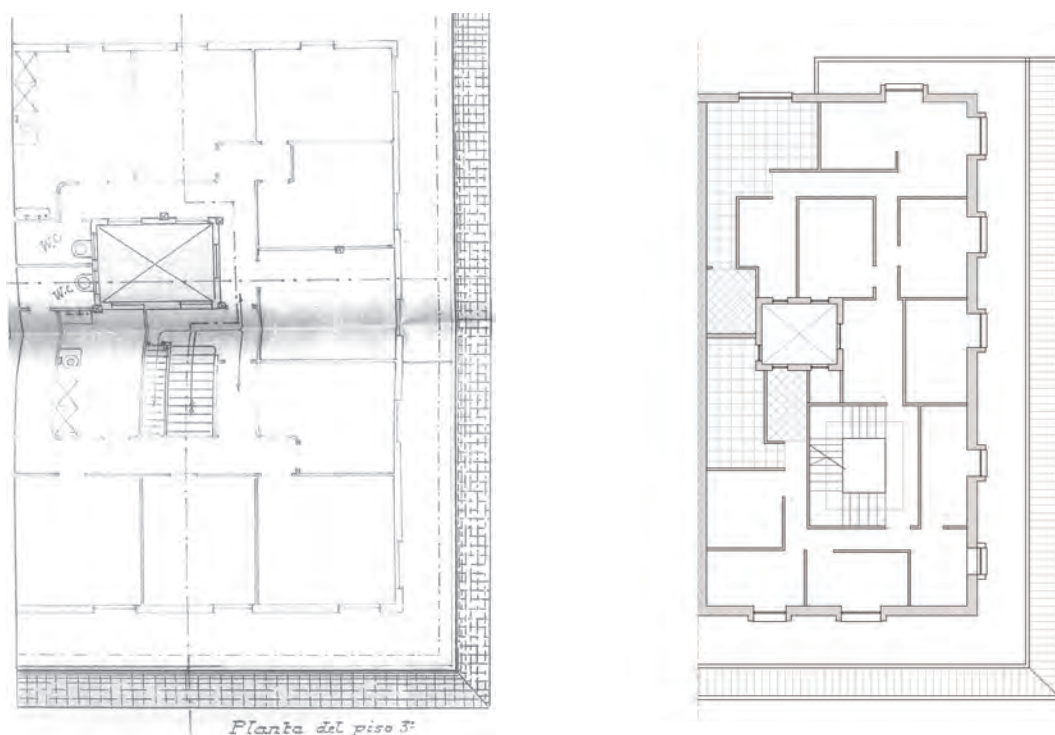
21. ESTADO PROPUESTO EN 1928 Y ESTADO ACTUAL DE LA TERCERA PLANTA
